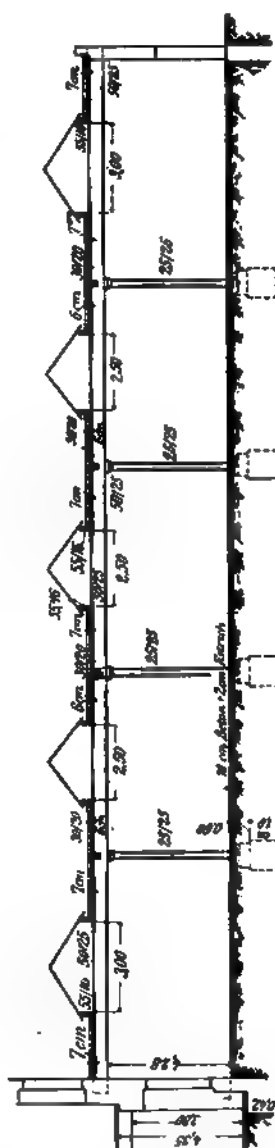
Schnitt A—B (zu Grundriß Abb. 116).
